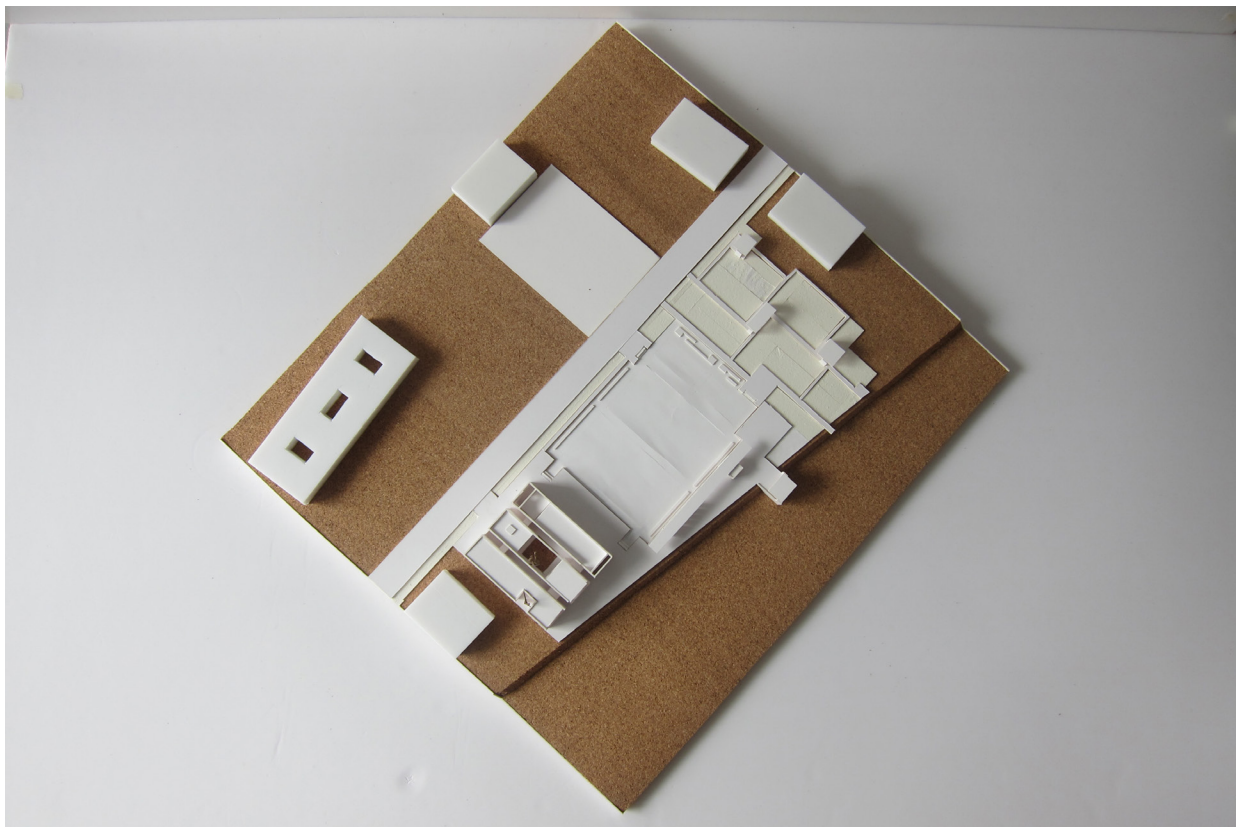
Maqueta 1:300. Planta de coberturas com envolvente.
